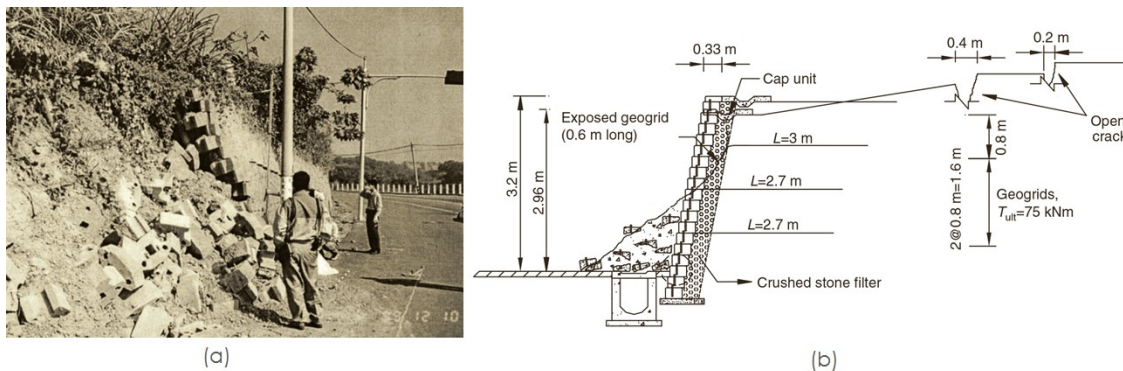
49 – Muro collassato in sito 2: (a) Foto; (b) sezione (Huang et al., 2003).
